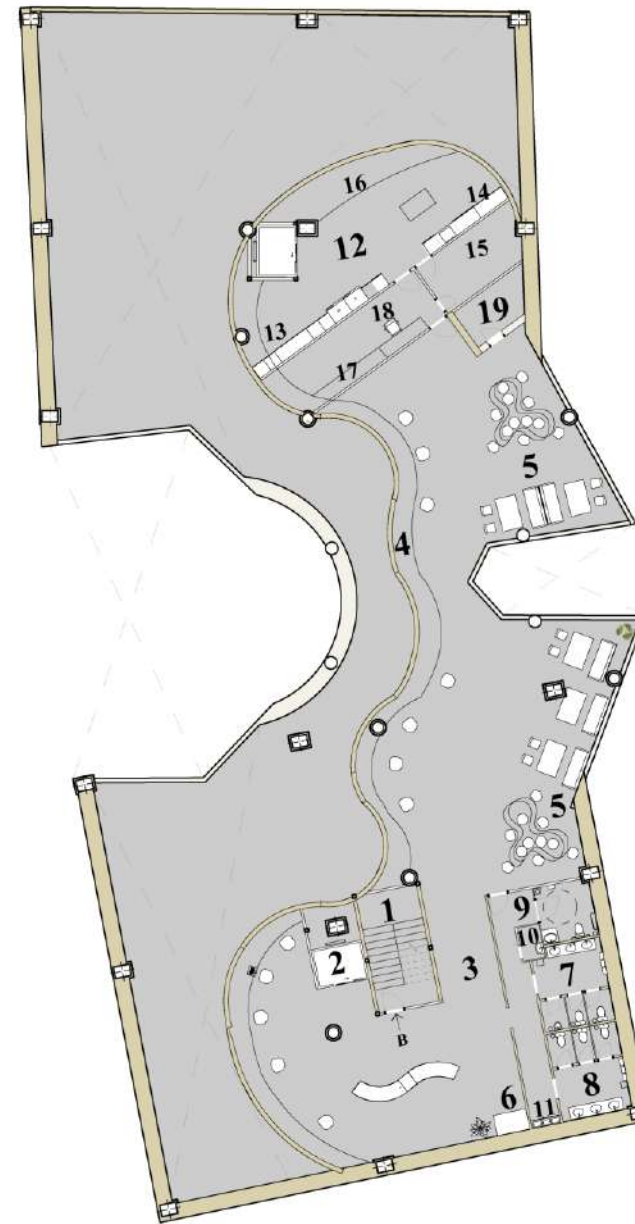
Planta Arquitectónica de nivel 02, edificio B, elaborado por autor, 2024.
